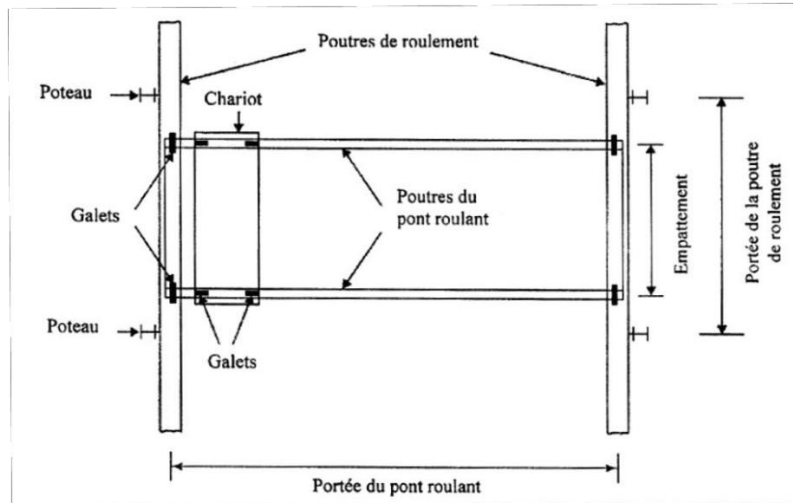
vue en plan sur le pont roulant bipoutre
